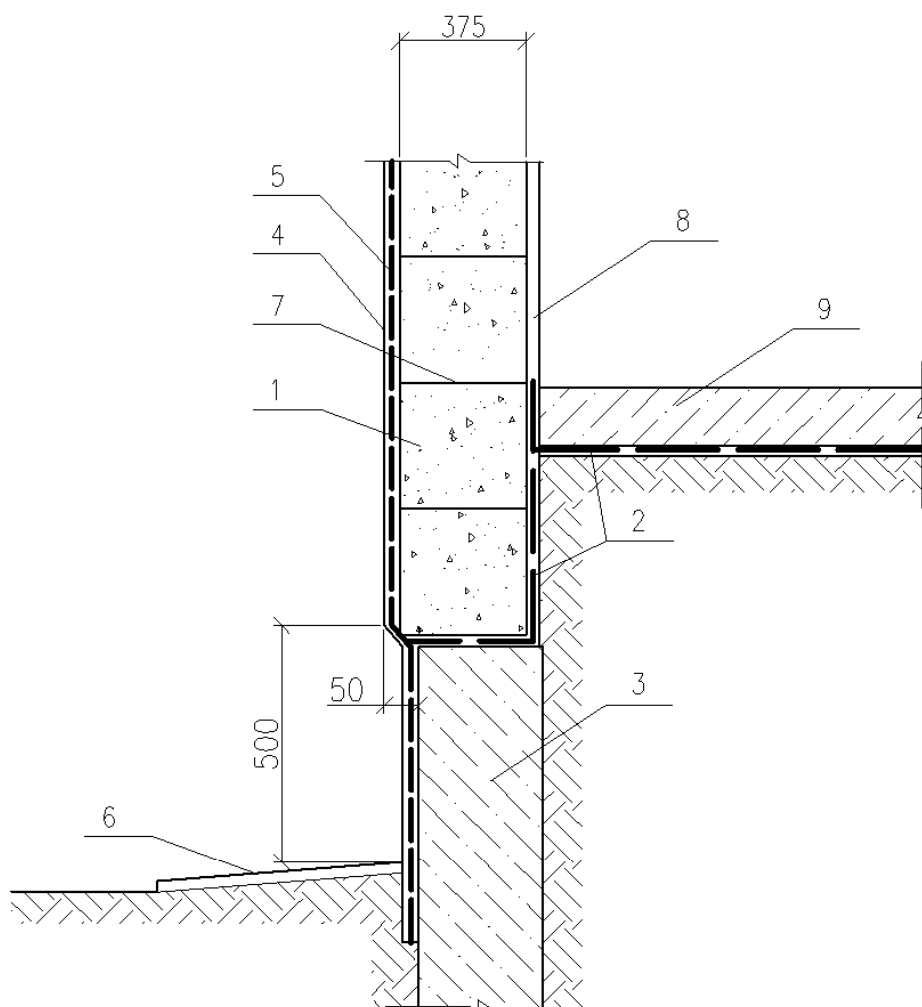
Схема гидроизоляции цокольной части стен, выложенных на плитном фундаменте
